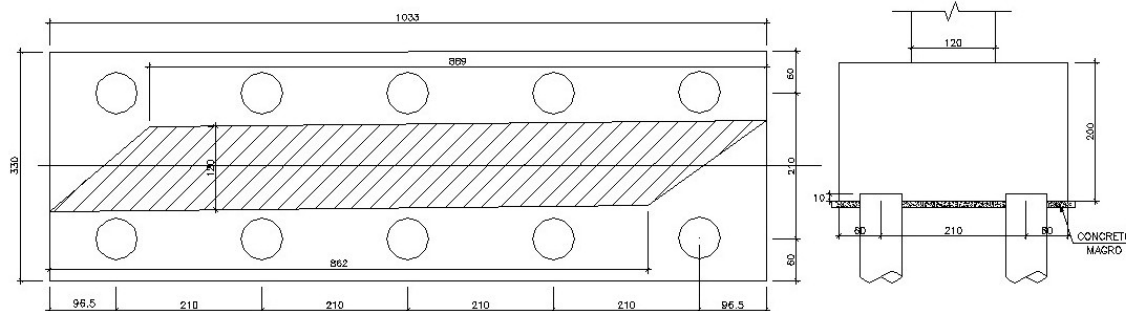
Geometria original do Bloco B4 do Viaduto Capitão Temudo..
